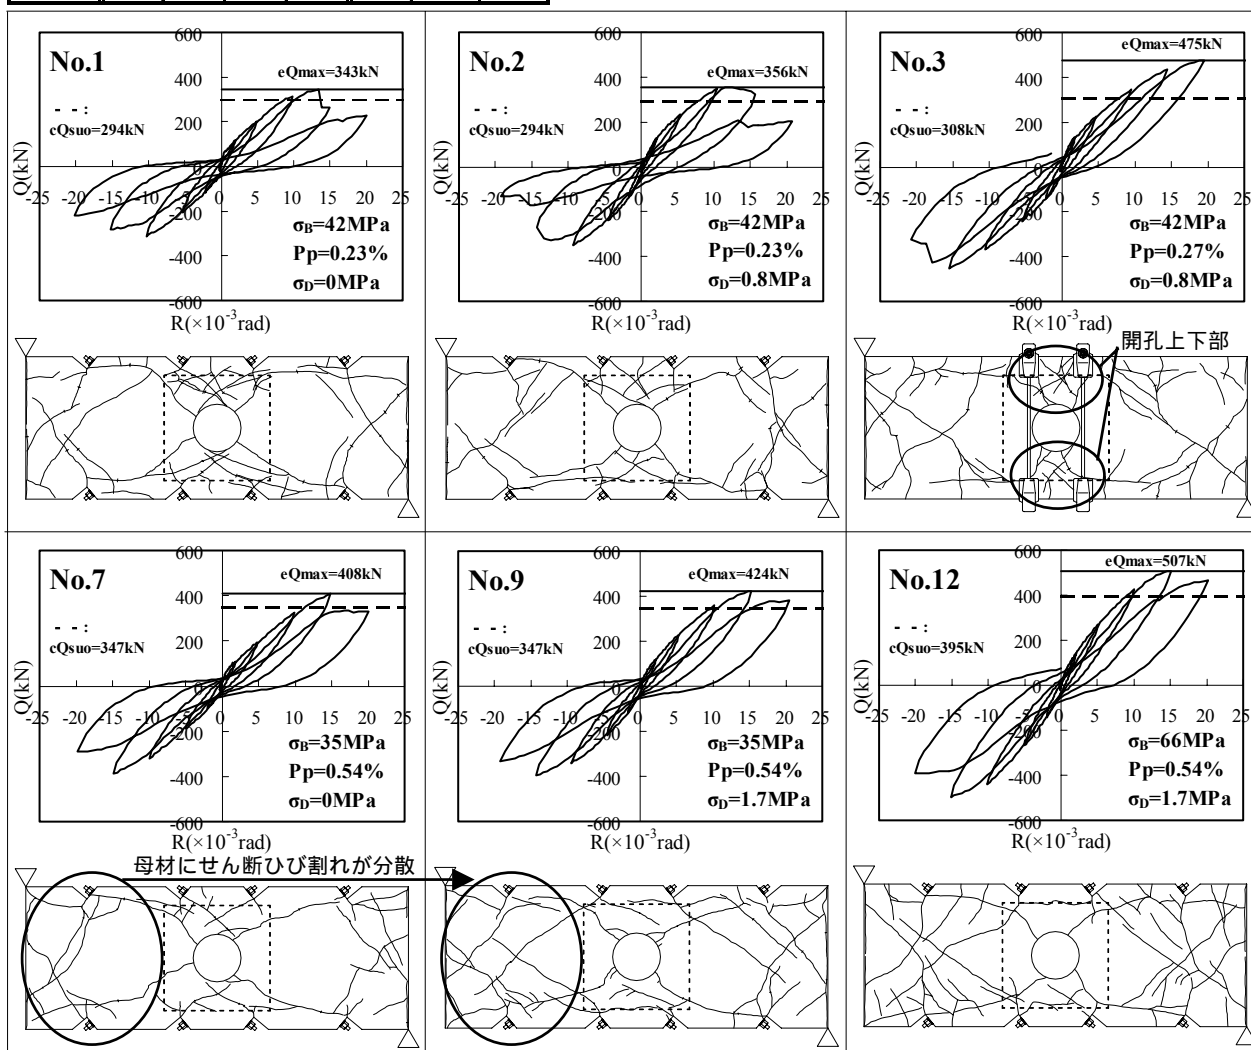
Q-R 曲線とひび割れ図 (破線枠: ひび割れ測定範囲)
